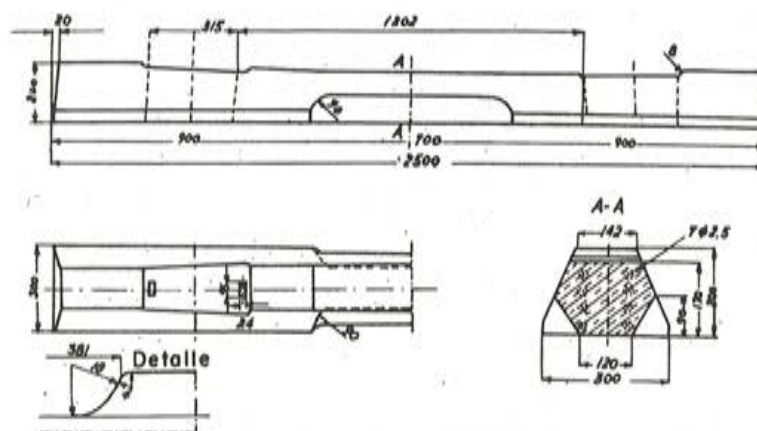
Traviesa de hormigón pretensado tipo JNBK-75.
